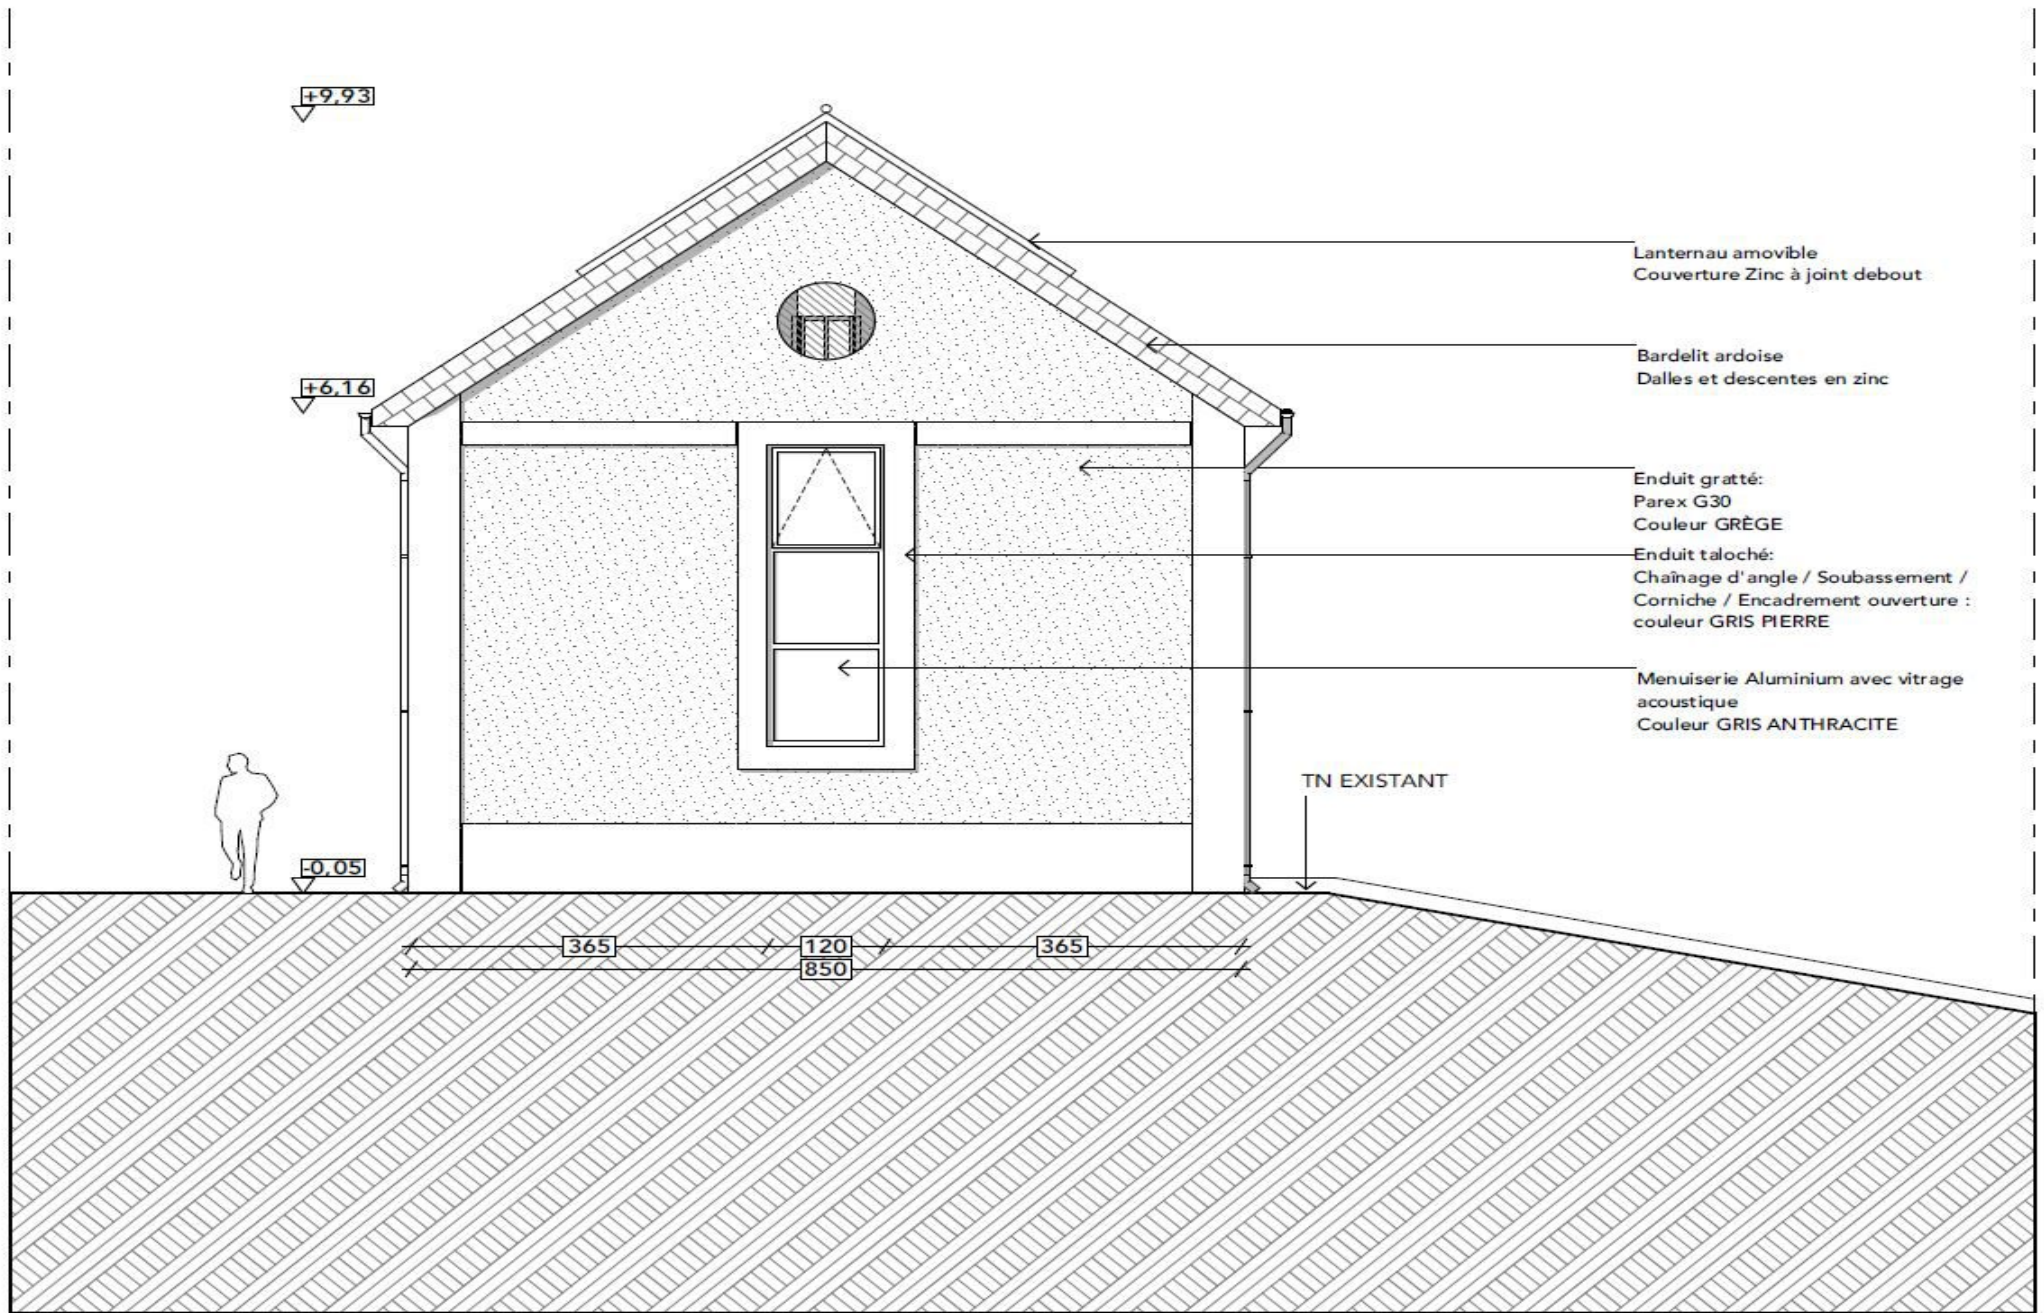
Façade est bâtiment centrale (source : PYREN et BB Architectes Associés)
